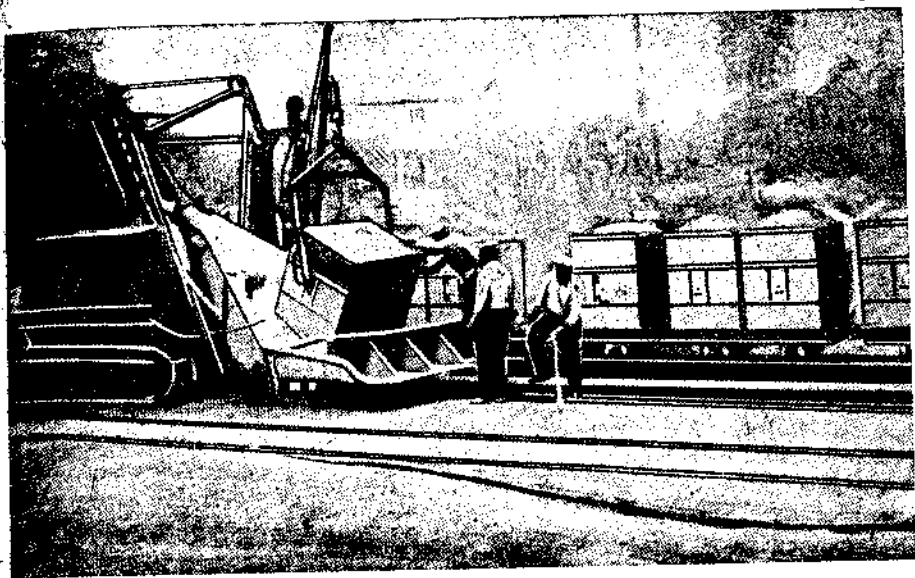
Подача материалов к бетономешалке поездом вагонеток, с выгрузкой вагонеток в ковш поворотным краном бетономешалки.
